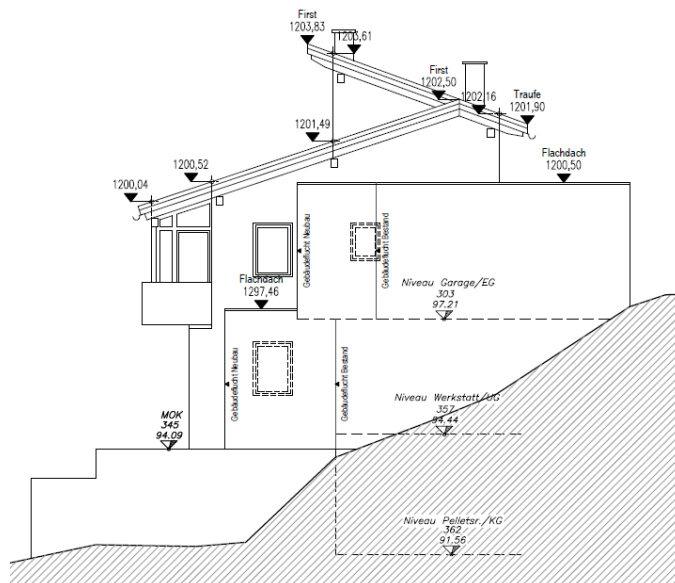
Ostansicht des Bestandsgebäudes mit dem geplanten Zubauvorhaben auf der Gp. 947/34 seitens des Planungsbüros R&S Planbau mit der Projektnummer „21-029“ und dem Plandatum 23.03.2022 (ohne Maßstab).
